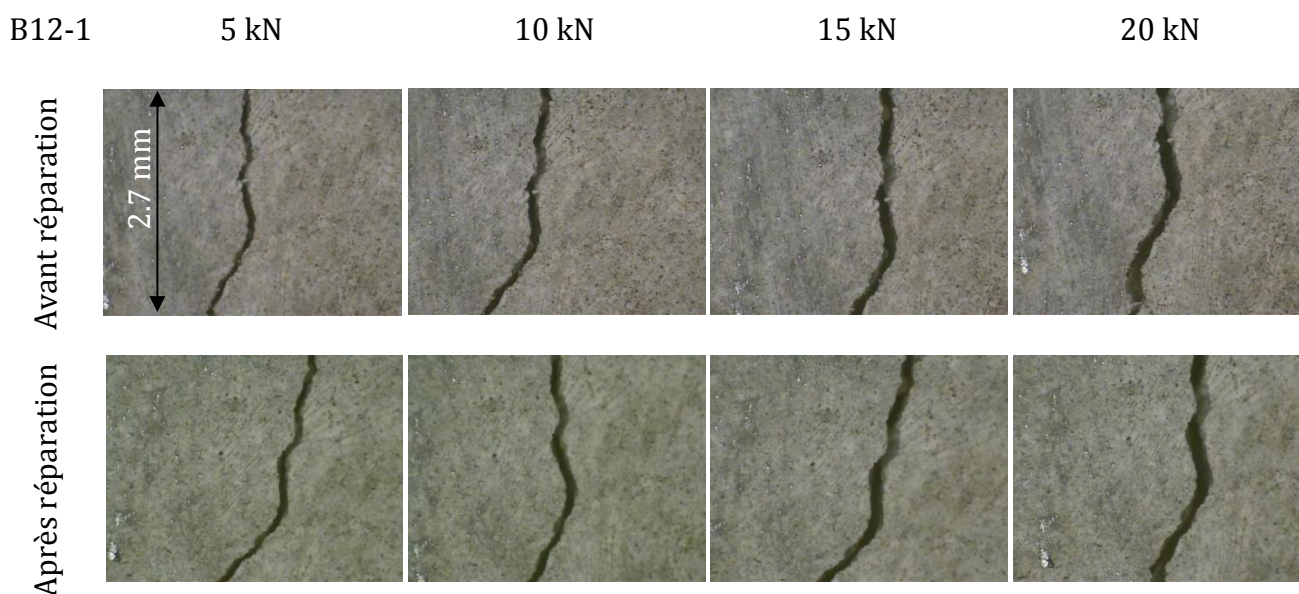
Exemple du suivi de l'évolution de la fissure  $f_1$  pour la poutre B12-1.
